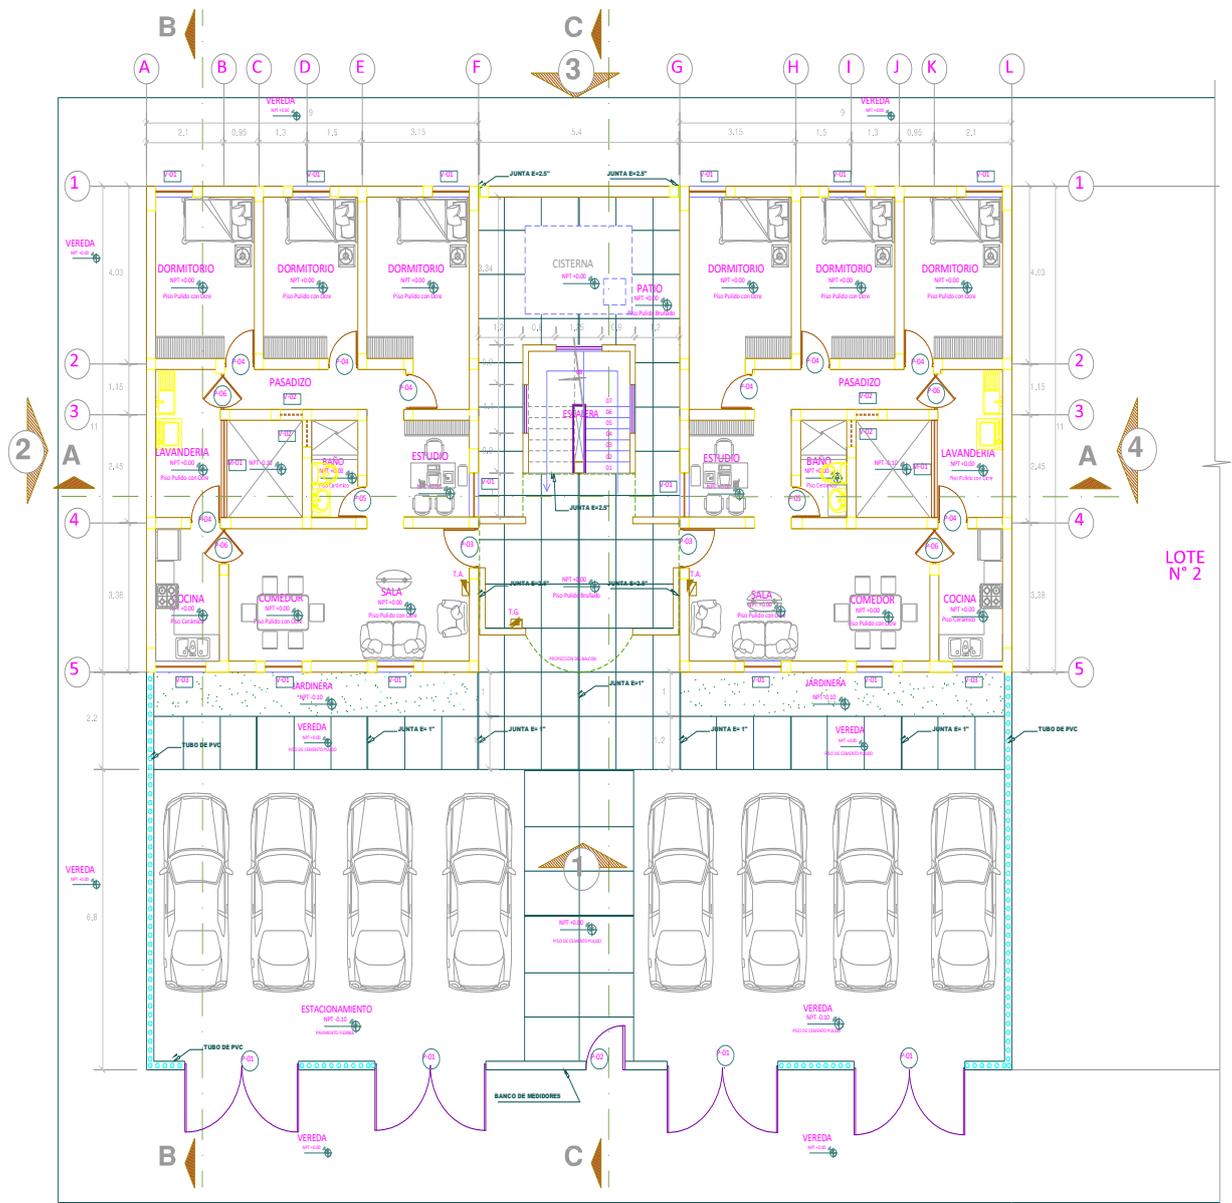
Vista en planta Bloque de departamentos primer piso.
